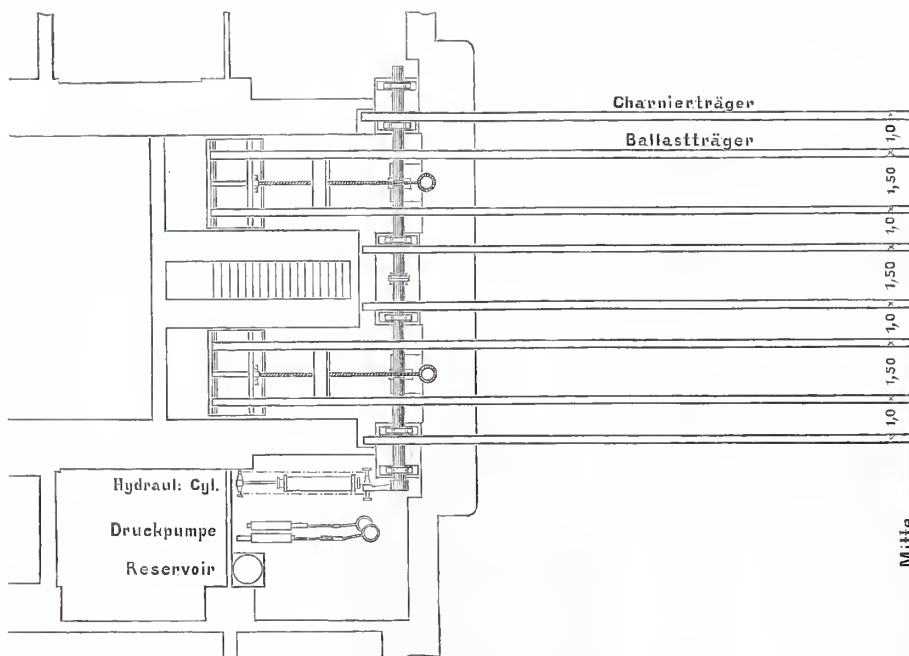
Grundriss. Maßstab 1:200.
